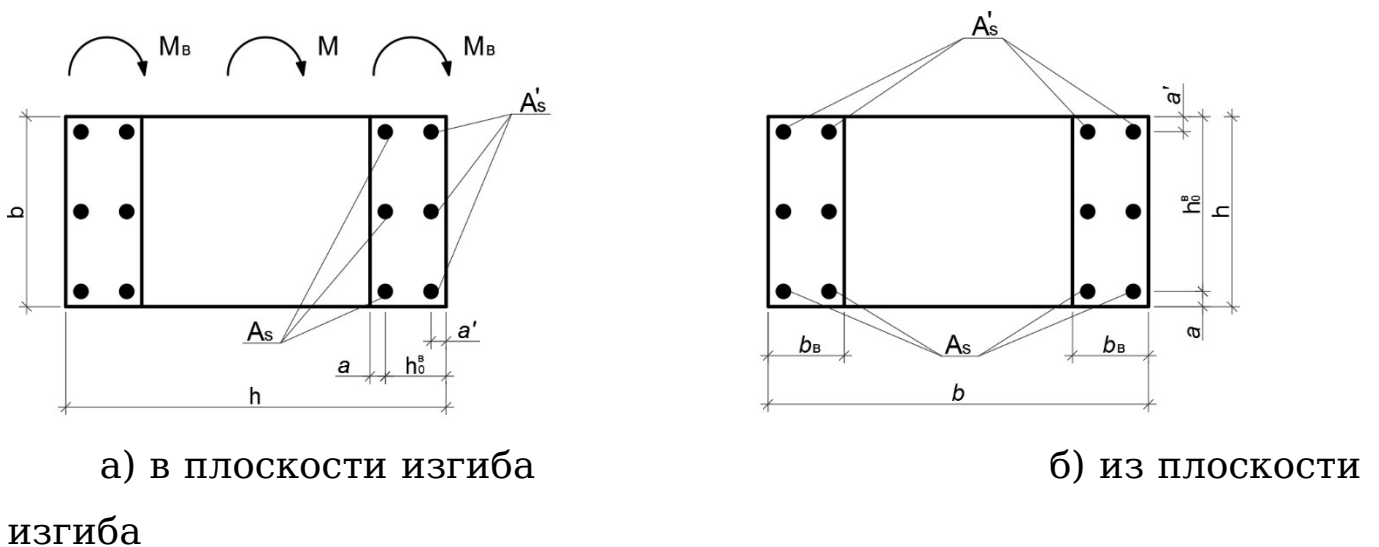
Расчетное сечение подкрановой части колонны (2-1)
